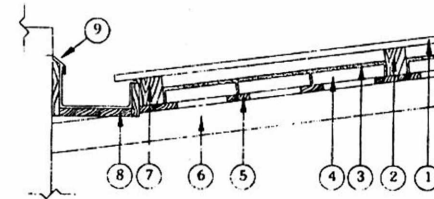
Cubierta de chapas onduladas de hierro galvanizado (corte transversal).
